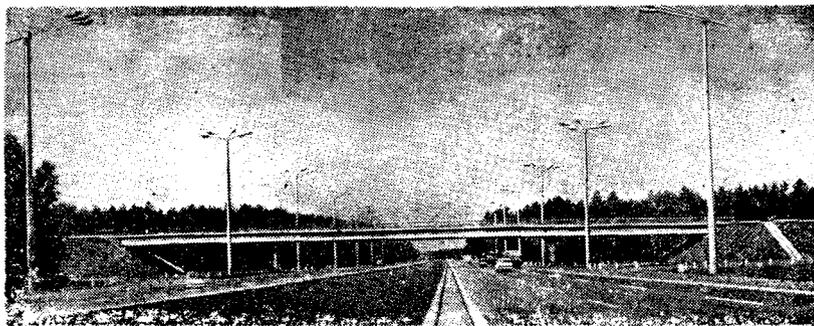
Путепровод на дороге Киев — Борисполь с трехпролетным железобетонным неразрезным пролетным строением без опоры на разделительной полосе
